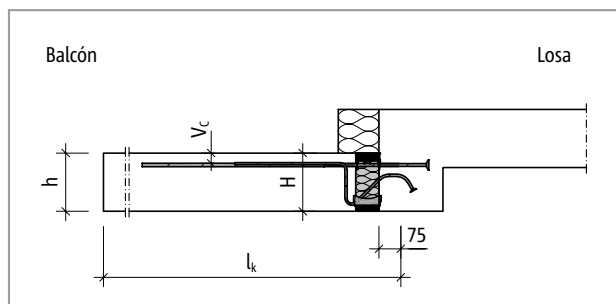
Schöck Isokorb® T tipo K-U: Sistema estático
